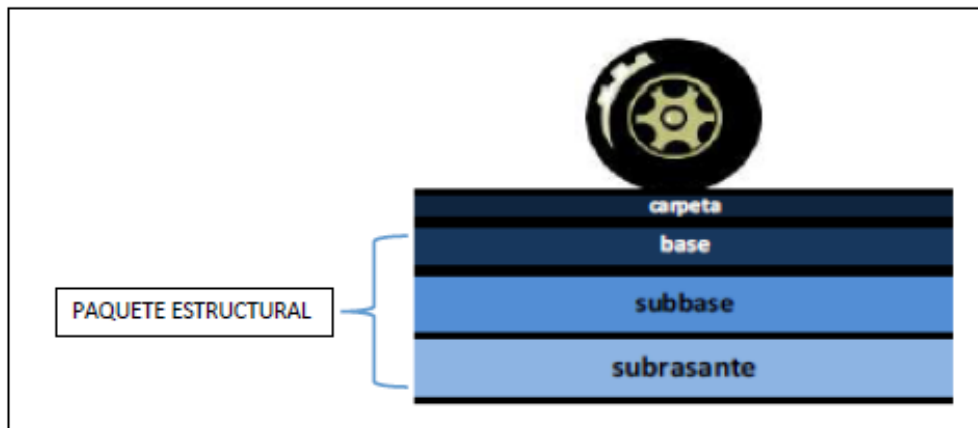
Esquema Típico Del Paquete Estructural De Un Pavimento Flexible. (Fuente: Vásquez, 2002).
